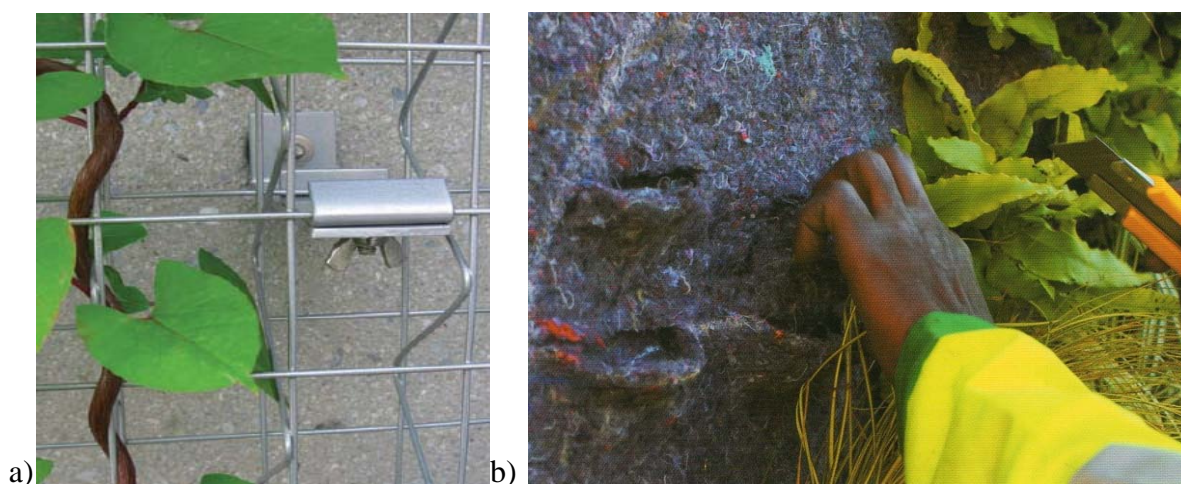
Diferentes estruturas implicam na escolha de diferentes espécies de plantas: a) sistema de Fachada Verde em painéis modulares obriga a uma planta trepadeira (Retirado de: Greenscreen, 2011); b) sistema de Parede Viva executada *in situ* obriga a plantas adaptáveis a condições de limitação de substrato (Retirado de: Groult, 2008)
